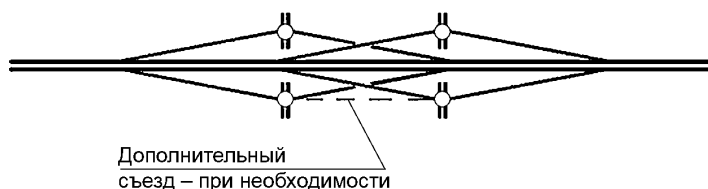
Схема планировочного решения с пересекающимися съездами
